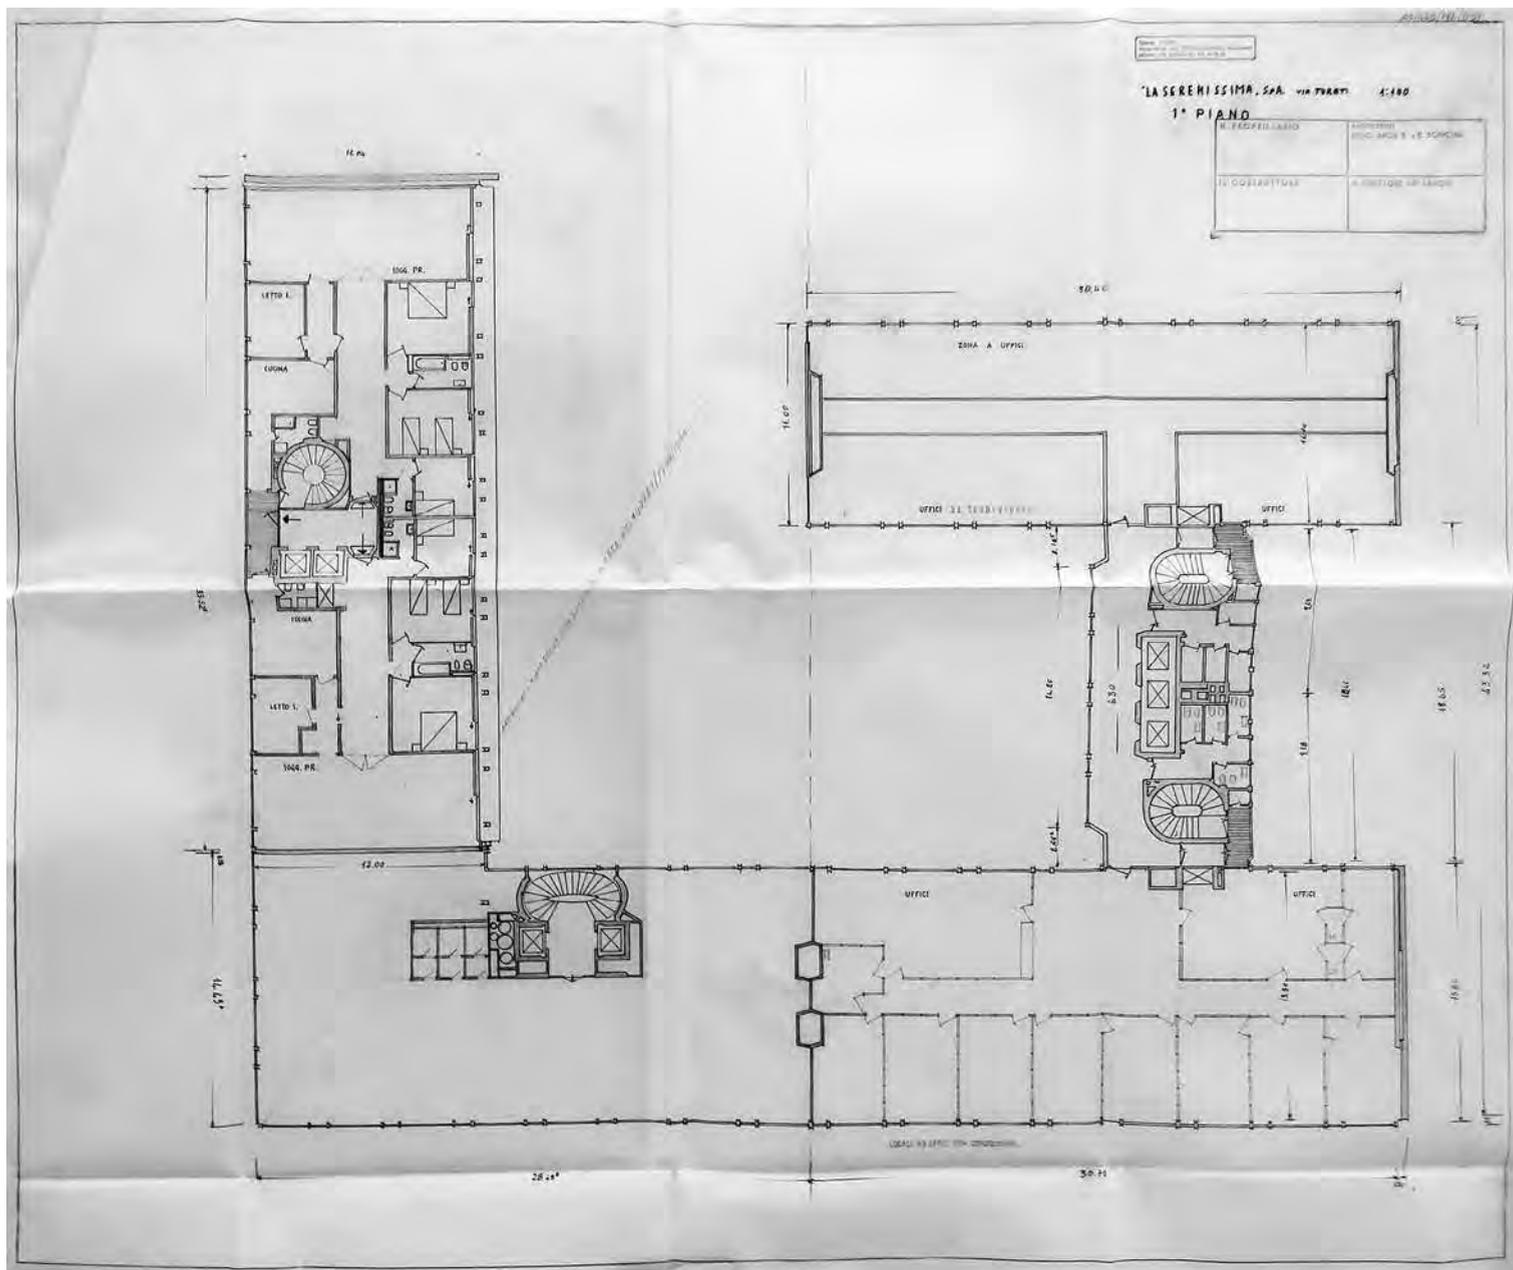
| Pianta del primo piano con l'organizzazione degli spazi di lavoro e residenziali (Archivio Soncini - © Comune di Milano - CASVA)
